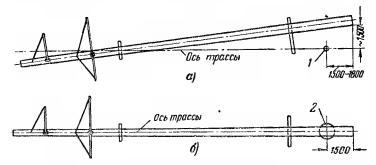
Выкладка железобетопных промежуточных опор для подъема краном КЛЭП-7.
